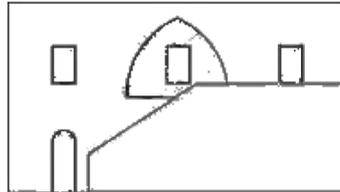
Das Haus mit dem "Liwans"- Grundriss, Ansicht & Bild
